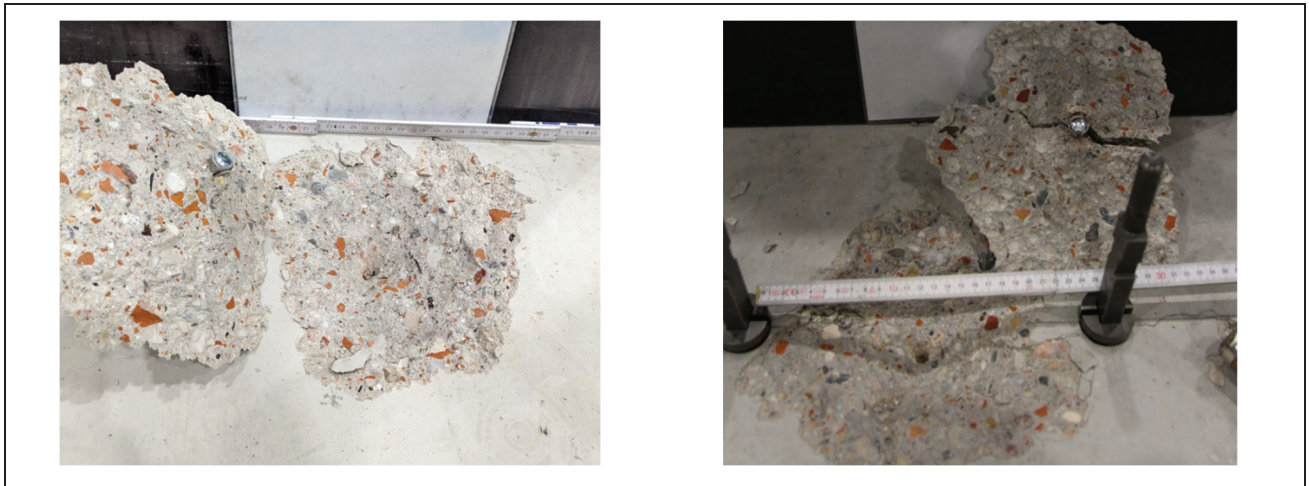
Versagensart kegelförmiger Betonausbruch, Bolzenanker F, links ungerissener, rechts gerissener Beton
